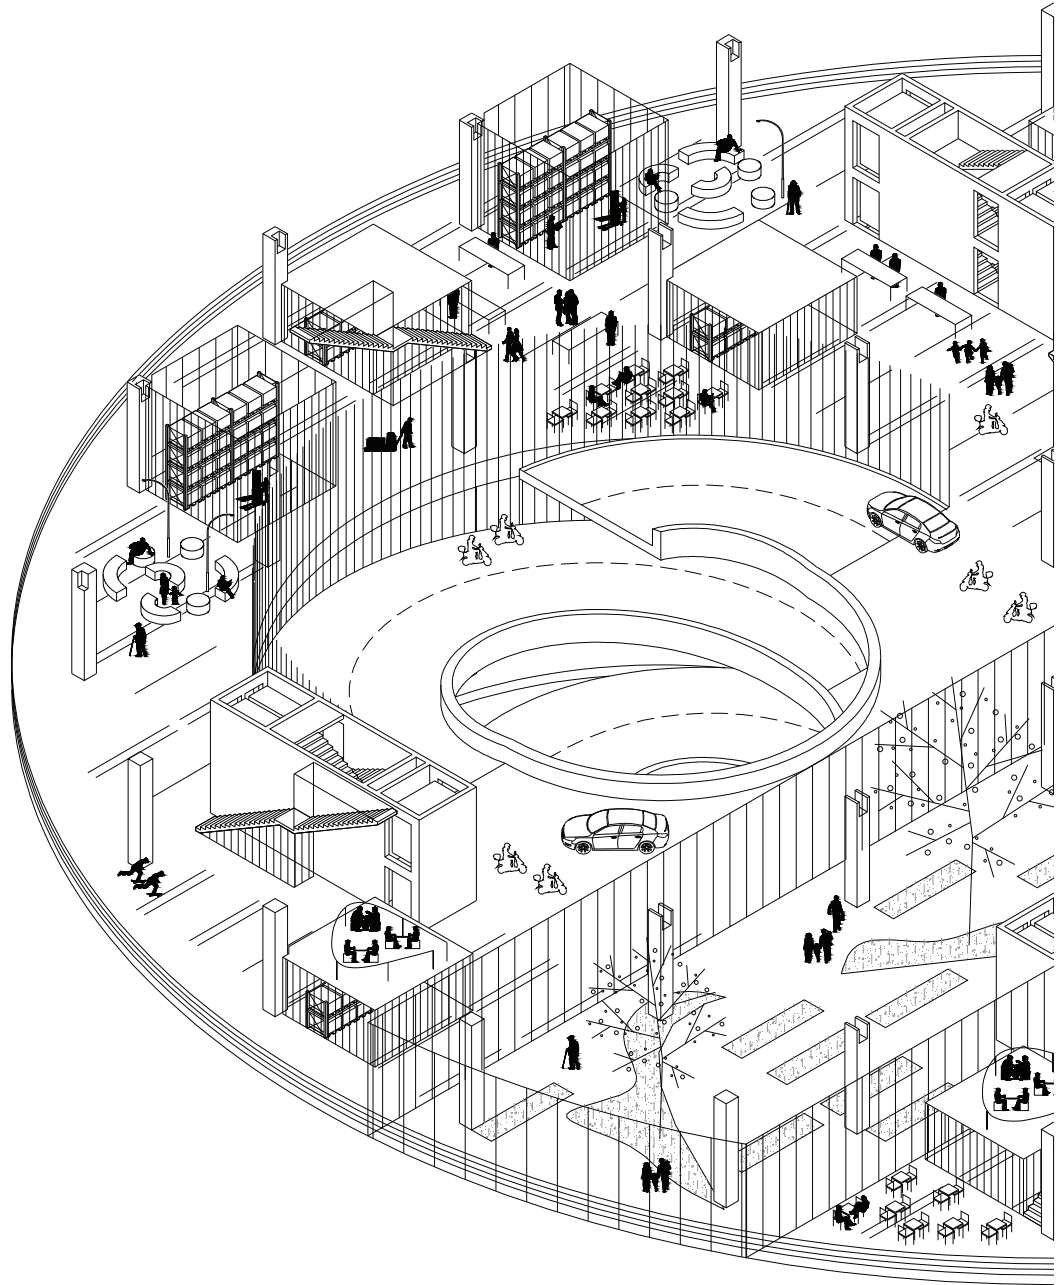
Grundrissaxonometrie . Parkgeschoss . 1:400
